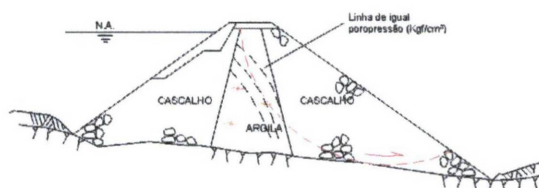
ESCORREGAMENTO GUIADO POR NÚCLEO INCLINADO (FINAL DE CONSTRUÇÃO)
